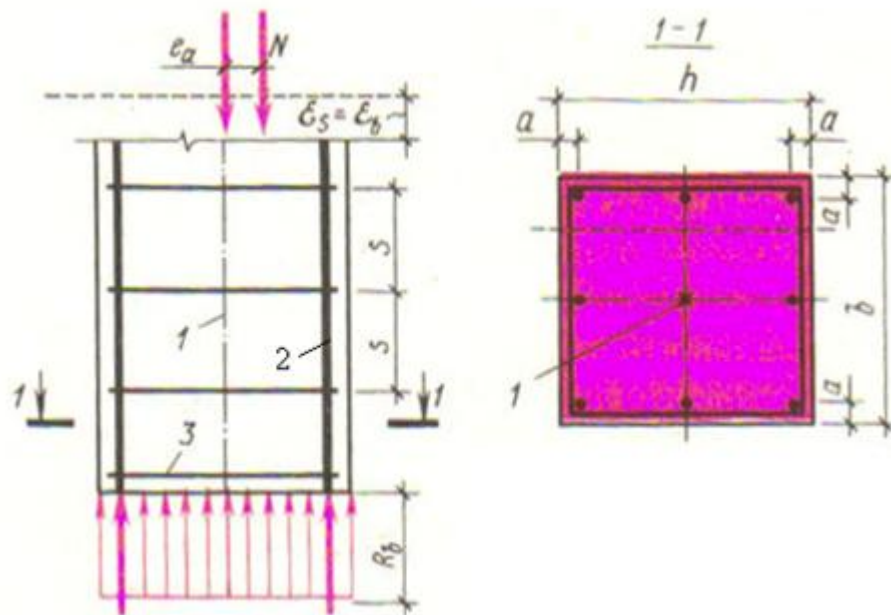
Розрахункова схема позацентрово стиснутого елемента із випадковим ексцентриситетом: 1 – геометрична вісь елемента, 2 – подовжня арматура, 3 – хомути
